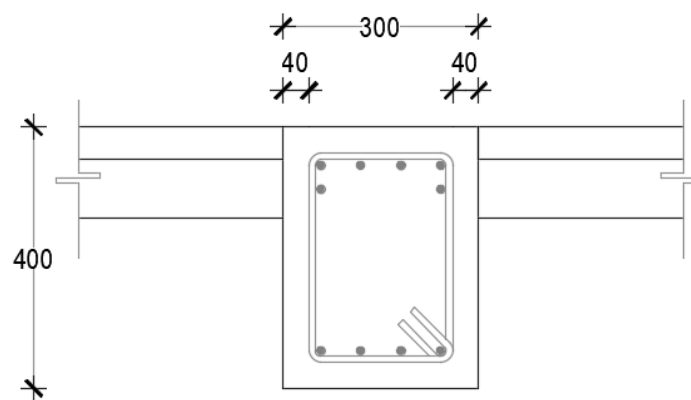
Sección dispuesta de viga principal B64 (más cargada)
